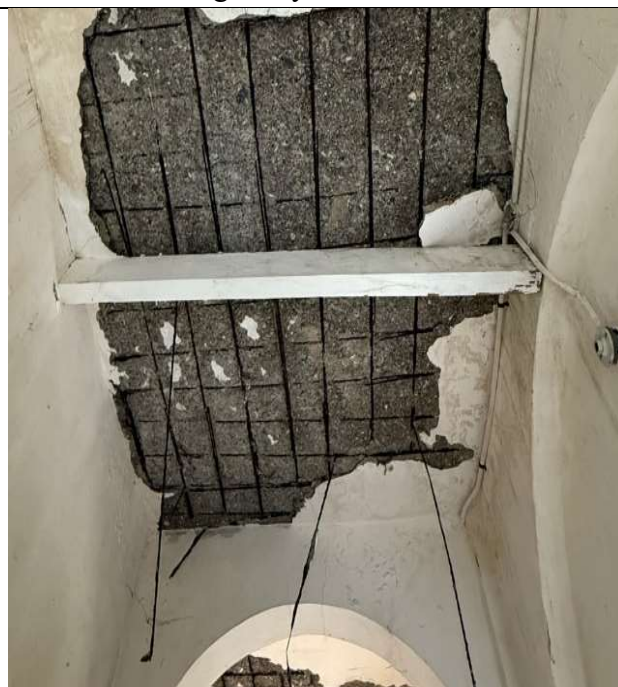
y 10 Desprendimiento del concreto, corrosión del acero de refuerzo y eflorescencias en la losa de entrepiso del sector norte.
